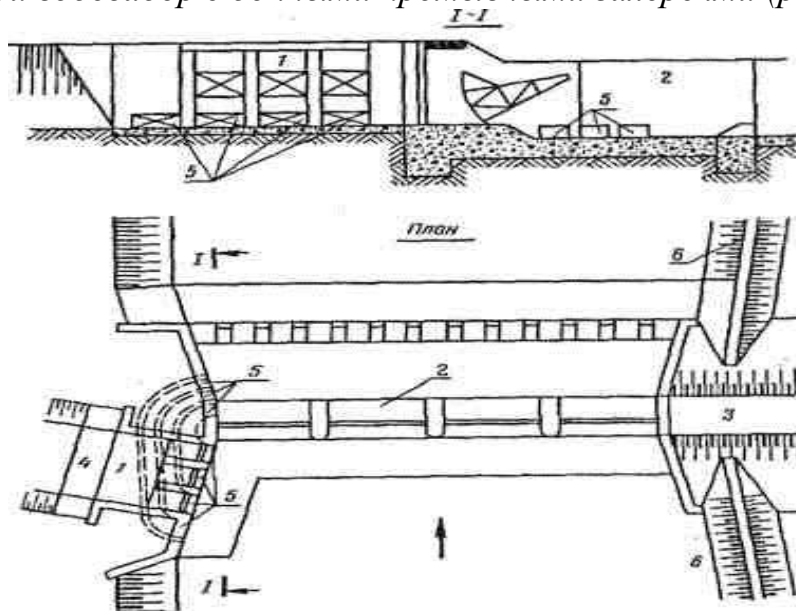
Боковой водозабор с донными промывными галереями:
